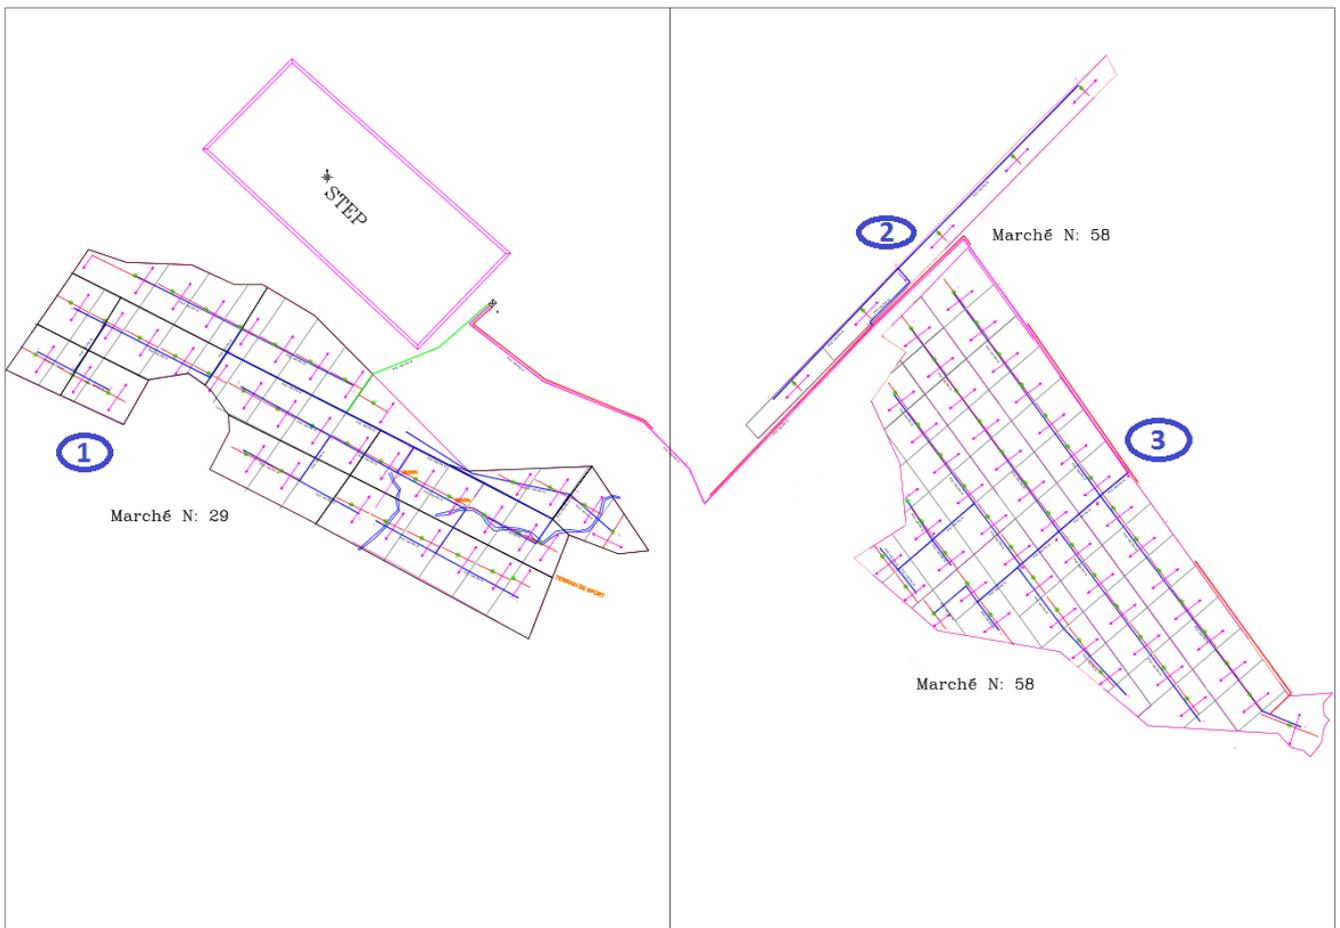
Plan de situation des 3 zones par rapport à la STEP.
